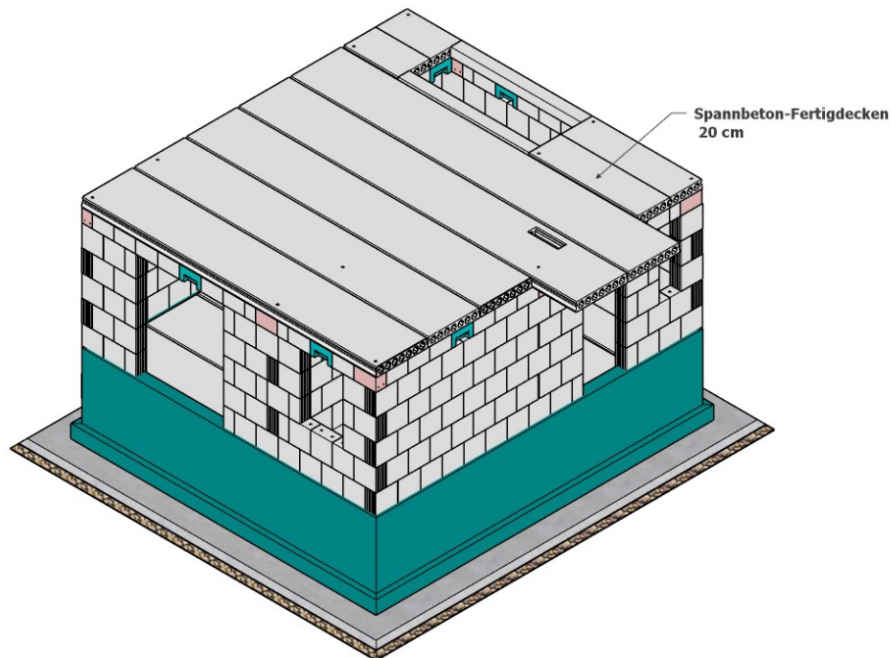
Verlegung der Deckenplatten über dem Erdgeschoß
